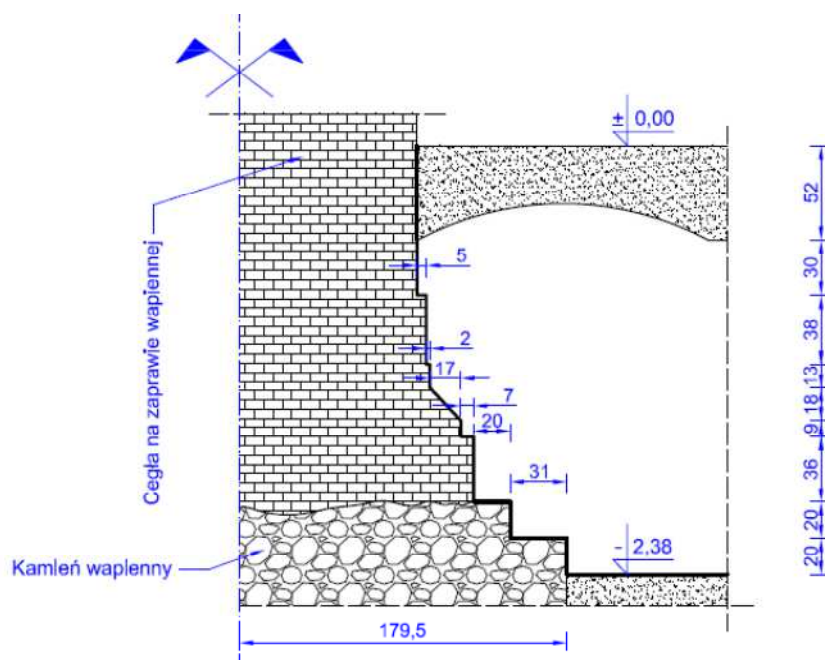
Odkrywka fundamentu i muru fundamentowego OF-2
